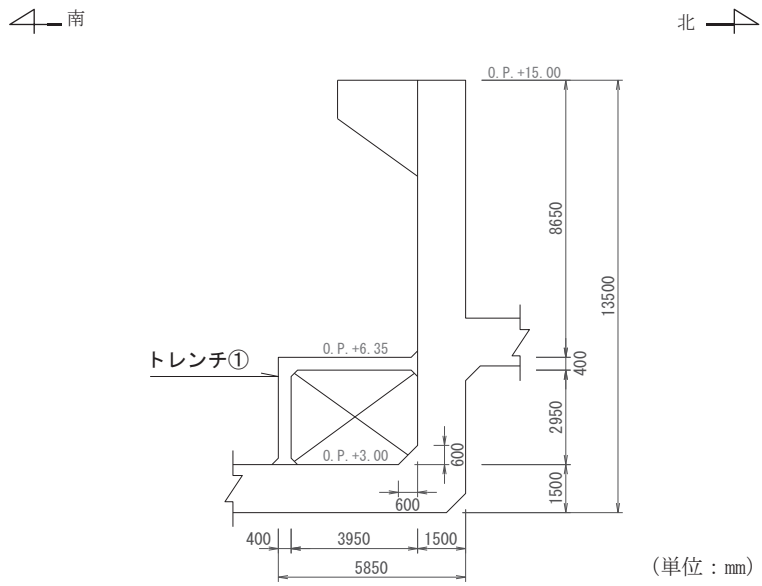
(7) 補機ポンプエリア断面図 (⑦—⑦断面)
